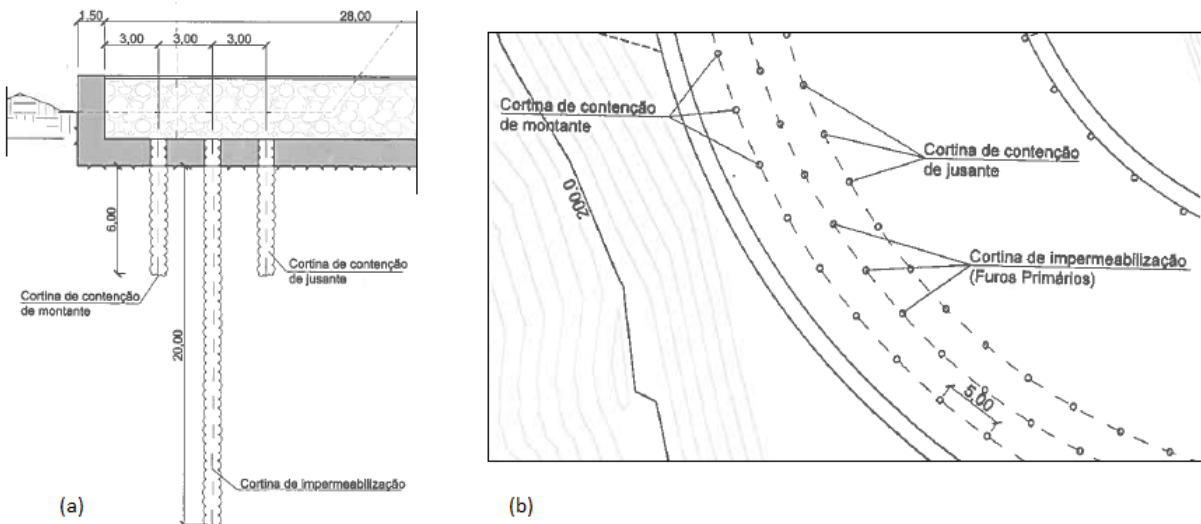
Ilustração da disposição das cortinas em corte e em planta, respetivamente [29]
